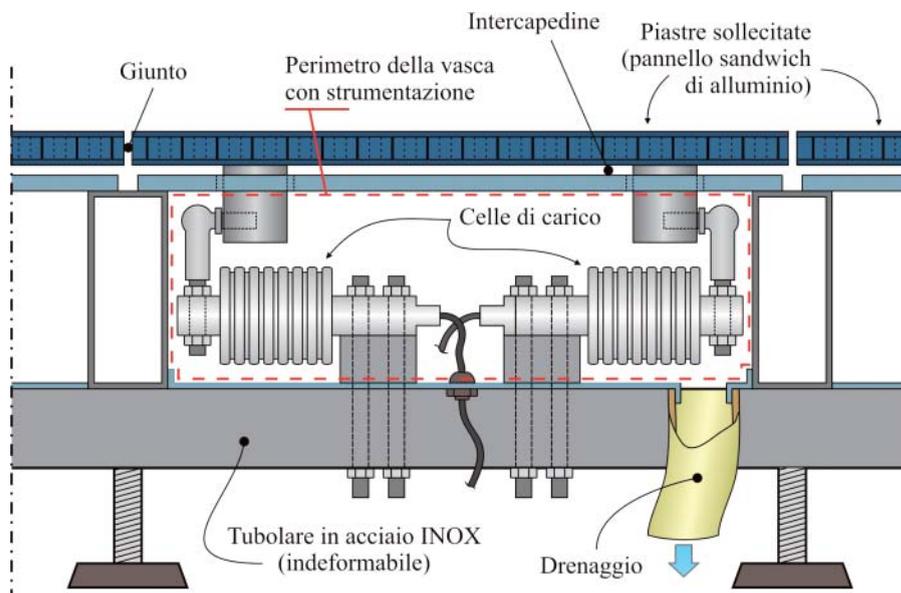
Sezione del traliccio in acciaio inox contenente la strumentazione
